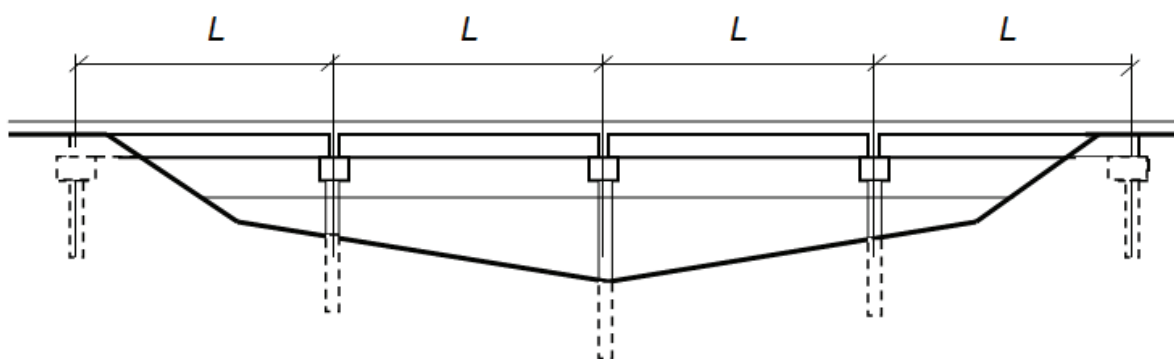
Схема моста с пролетными строениями из пустотных плит
